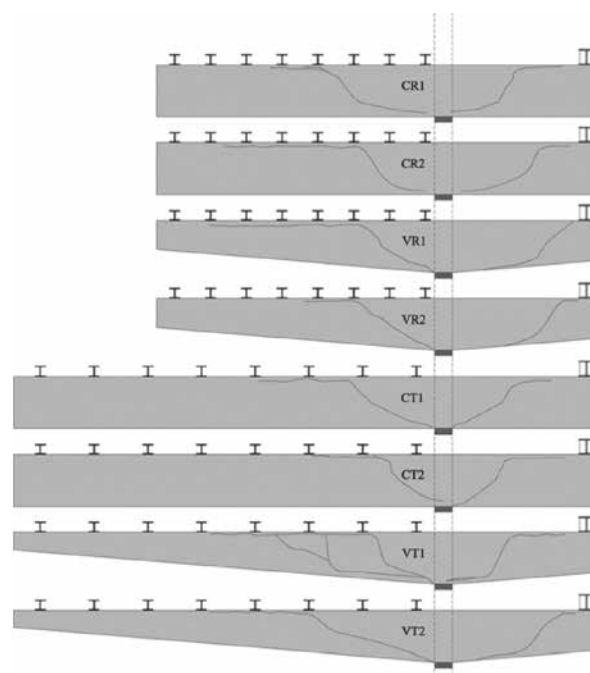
Fisuras críticas de cortante para cada viga.
